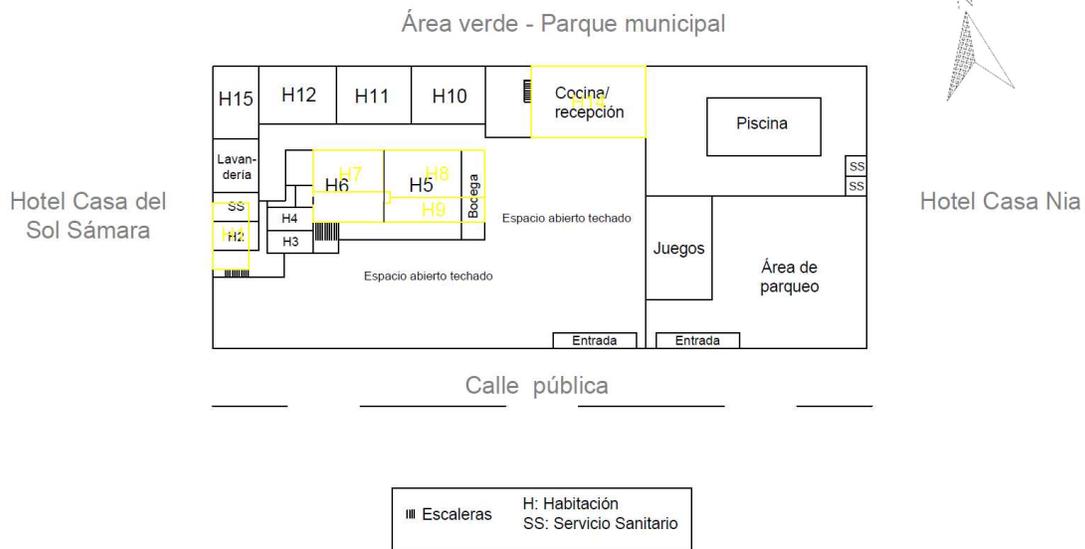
Vista general de planta del HPPS. Traslape de la planta alta (en amarillo) y de la planta baja (en negro) Nicoya, Guanacaste
